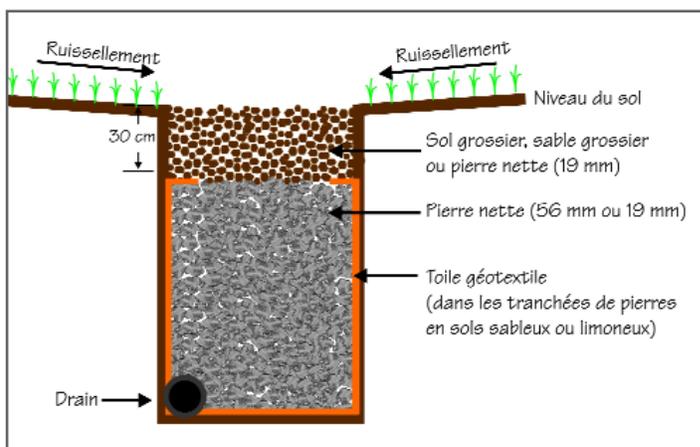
Tranchée filtrante avec pierre - sol travaillé
